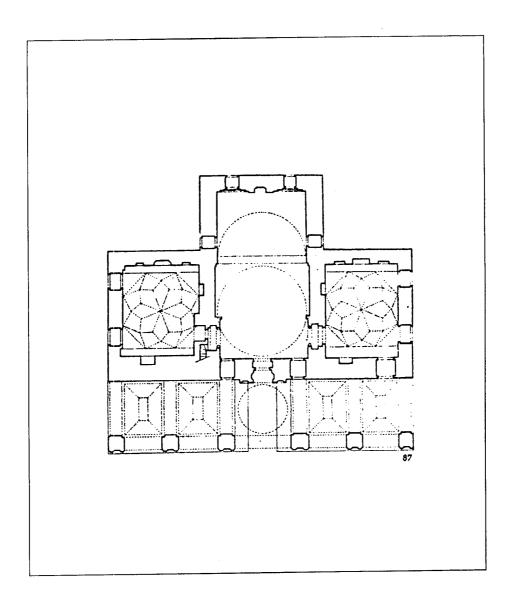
مسقط أفقي لمسجد الفاتحية الصغير في أثينا (عن : اصلان ابا)
